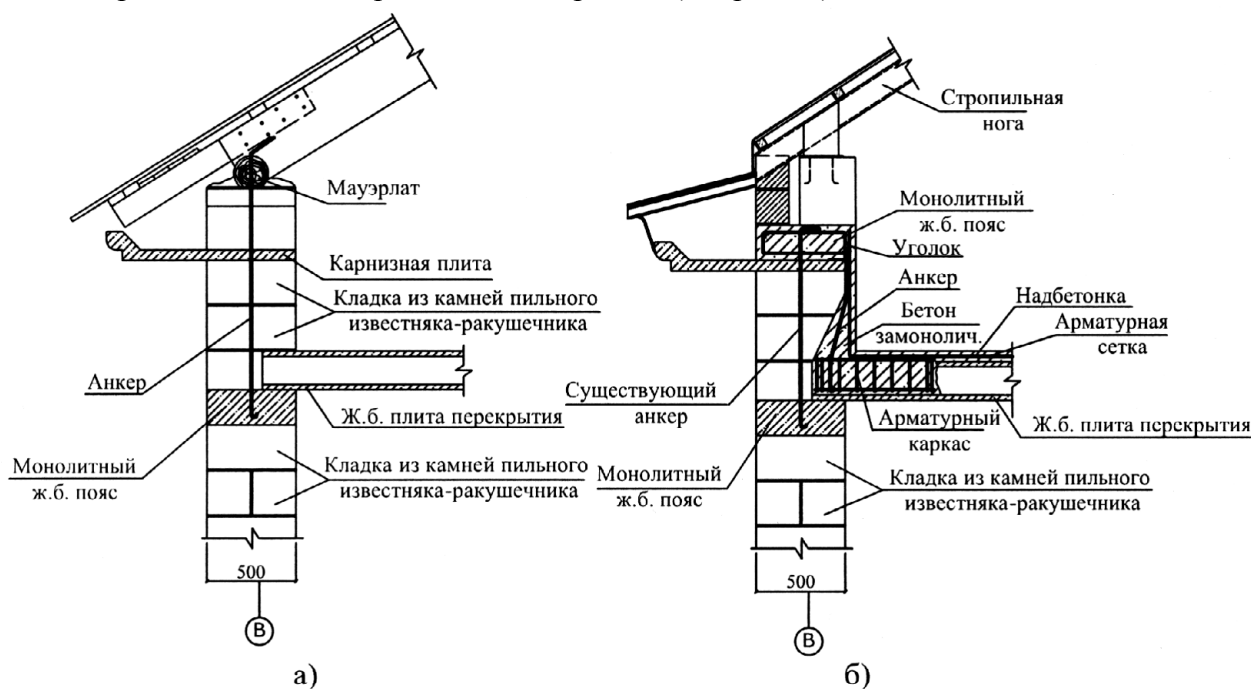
Схема фактического исполнения (а) и схема усиления перекрытия и участков стен над чердачным перекрытием (б).
